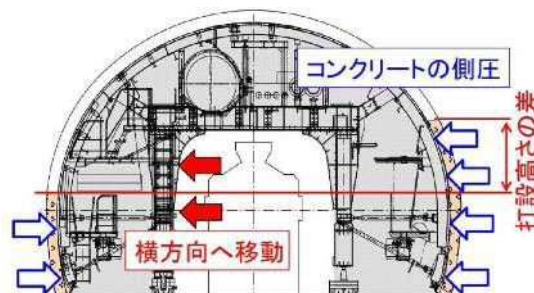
コンクリート側圧によるひび割れ発生¹²⁾
